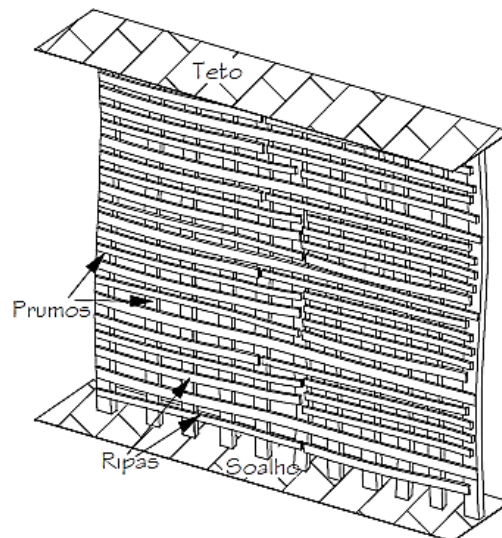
Esquema da solução estrutural de madeira de uma parede interior, tipologia B
